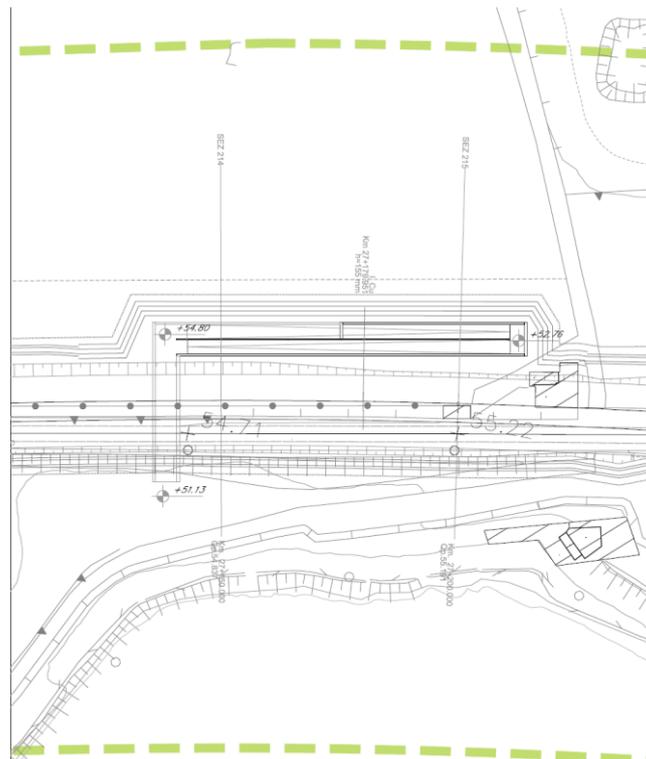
Planimetria del sottopasso in corrispondenza del lago di Telese
